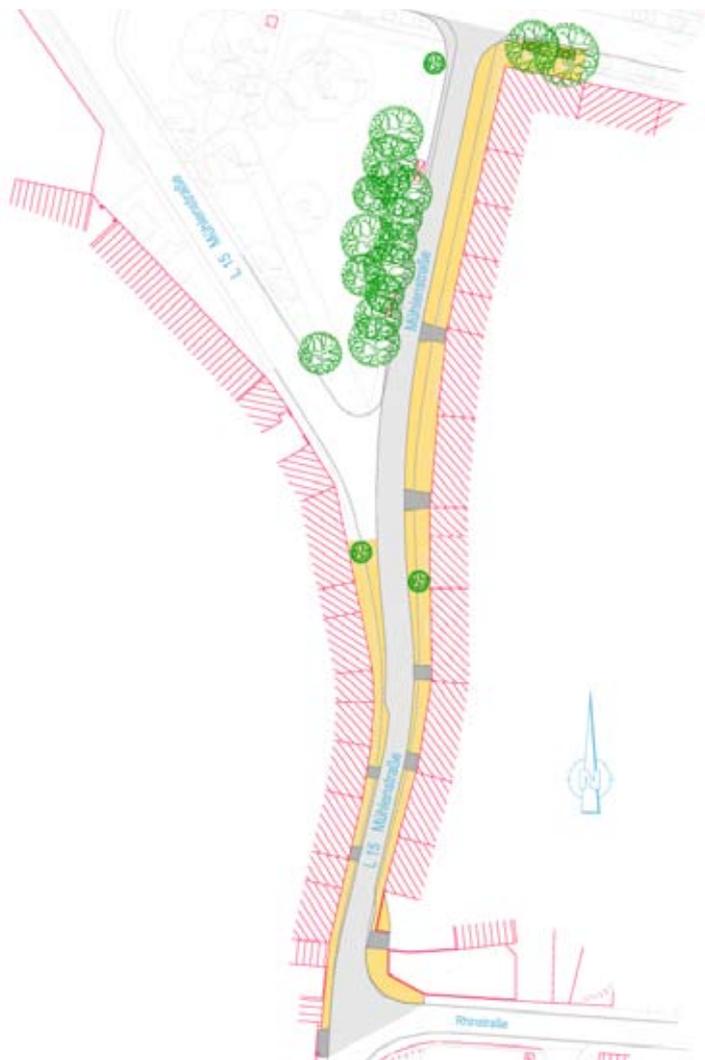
Variante 2: Mühlenstraße mit Engstelle, Lageplan, M 1:250 im Original
